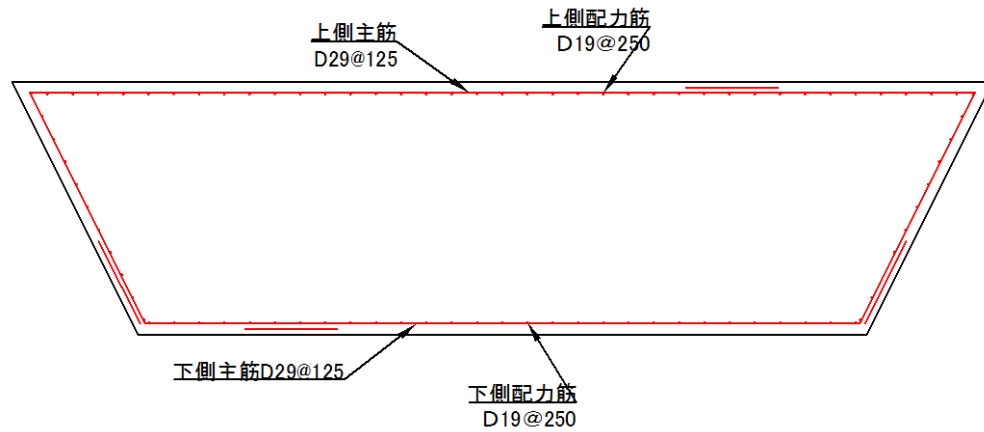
配筋要領図（③-③断面置換コンクリート）
